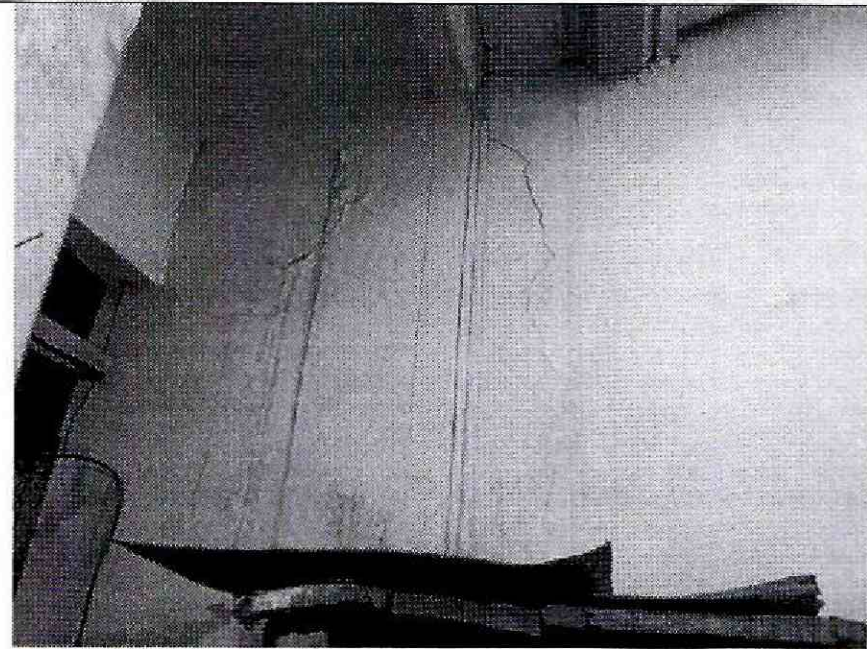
Muros del costado sur tramo frontal con grietas.
